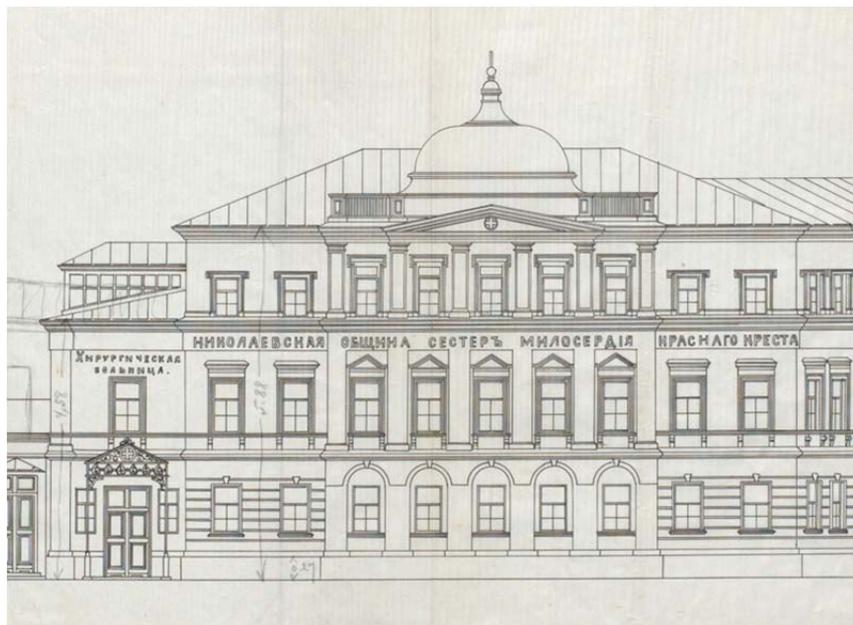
Воронежская. Община. Главный корпус. Фасад. Фрагмент чертежа [9]
